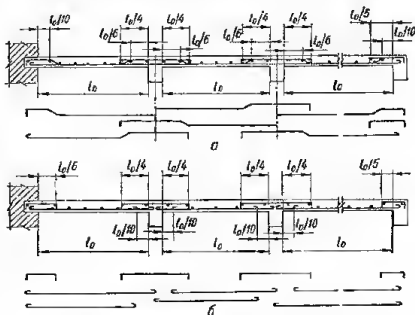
Армирование многопролетных балочных плит вязаной арматурой:
